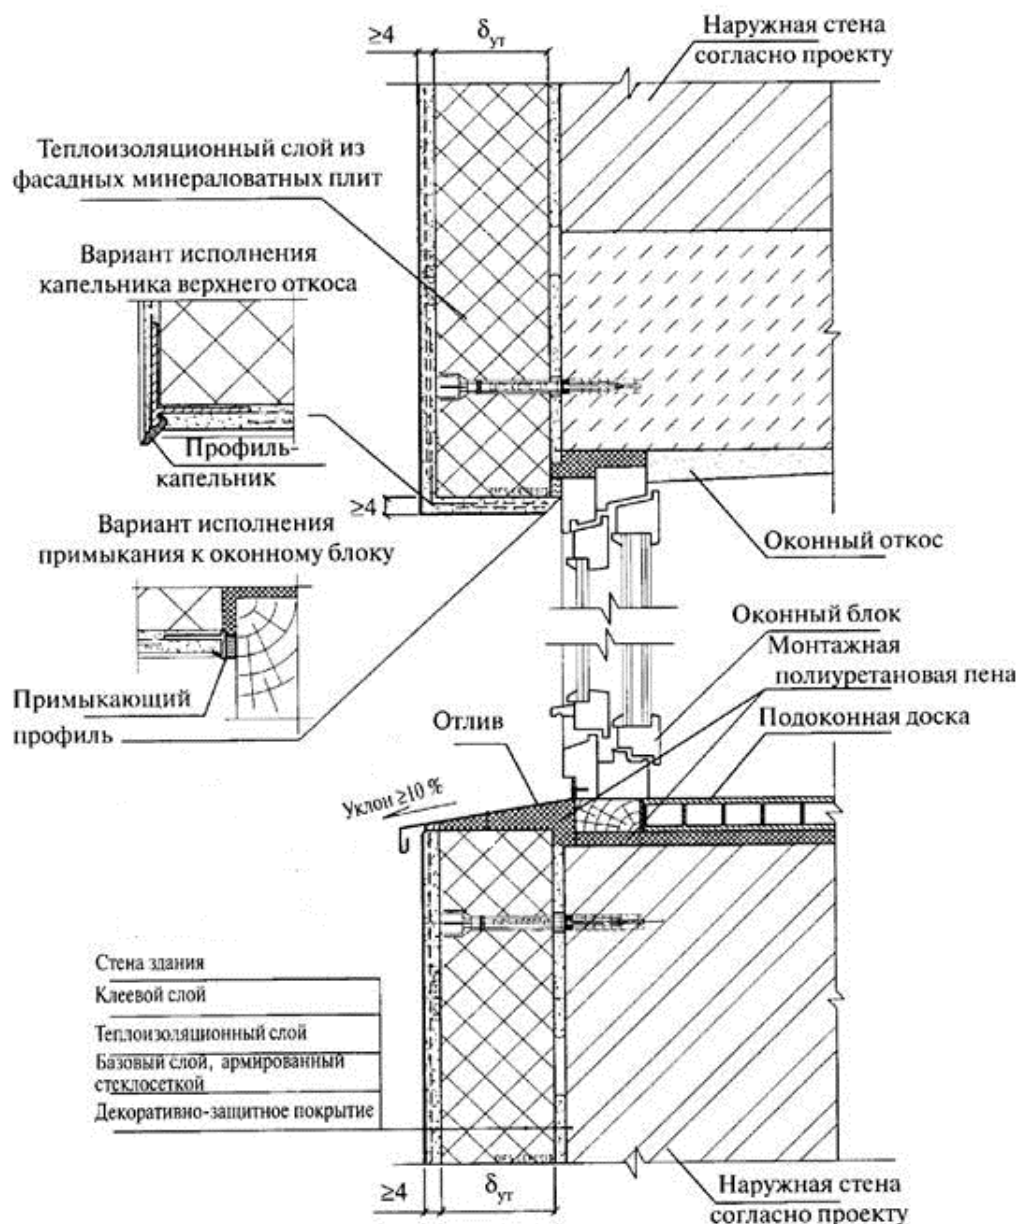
Примыкания теплоизоляции к оконному проему (вариант "с четвертью")
